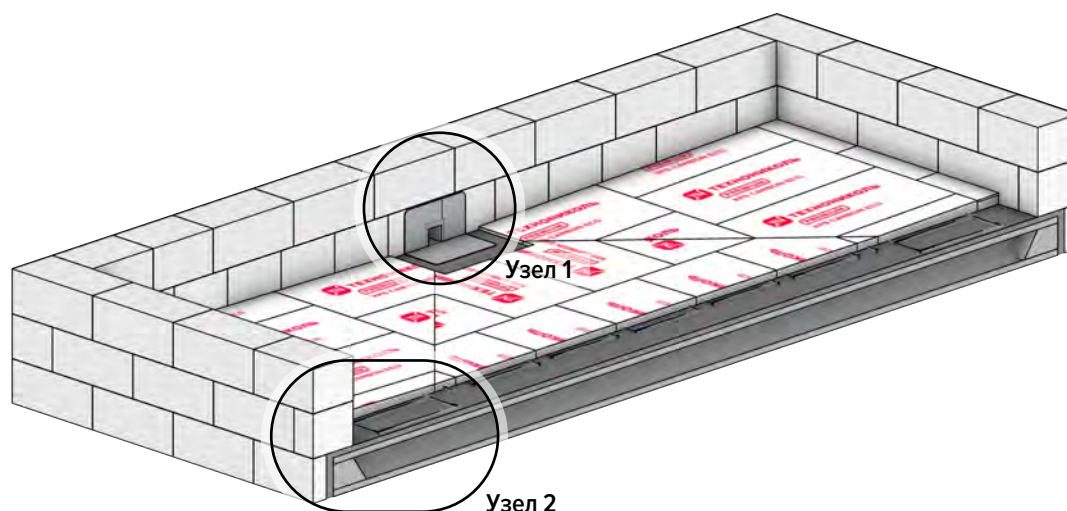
Конструкция плоской крыши с железобетонным основанием
